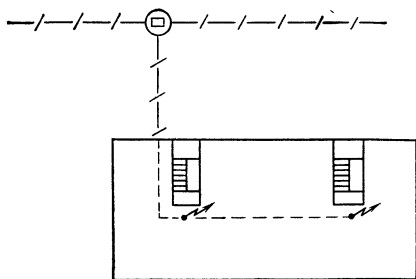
Ввод кабеля через подвал здания по трубопроводу или бронированным подземным кабелям
